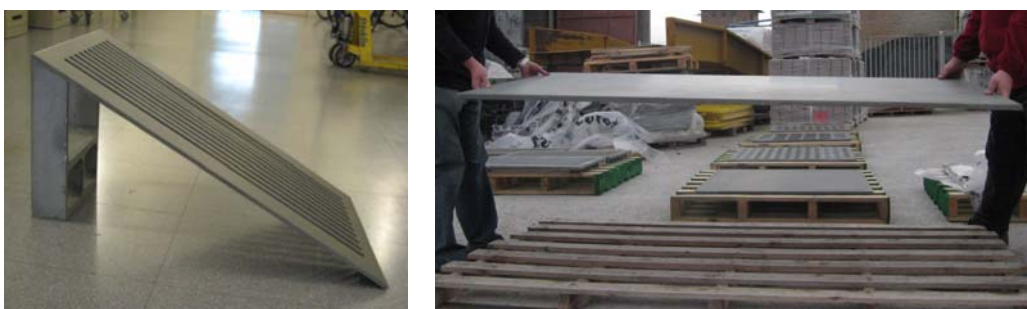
Paneles para la hoja exterior de la fachada ventilada de 10 y 20mm de espesor.
